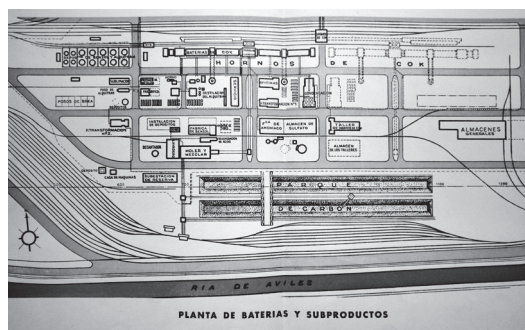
Planta de baterías de cok y subproductos en su primera fase constructiva. Fuente: *Baterías de cok y planta de subproductos*, INI, 1956.
